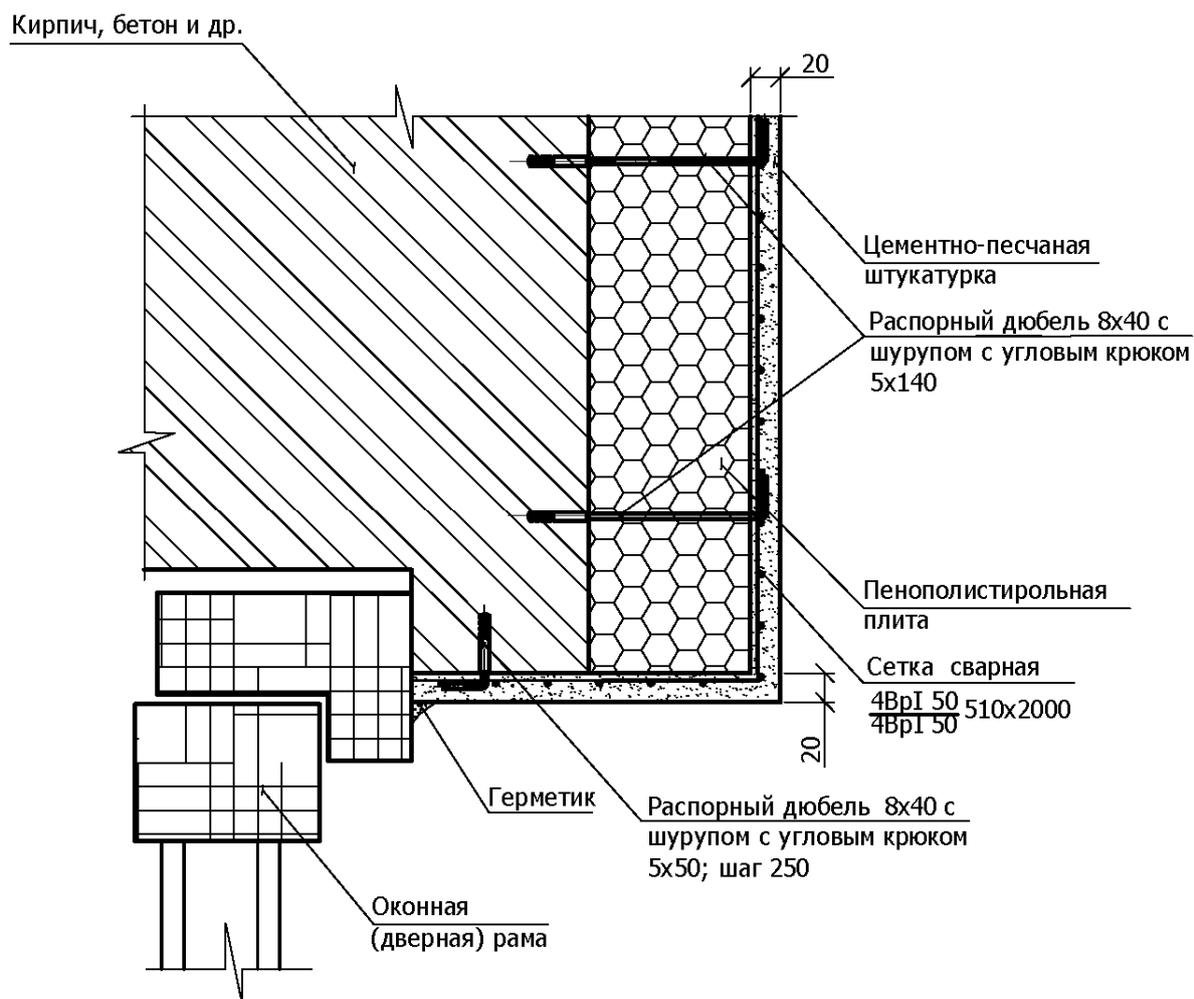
Утепление остекленных лоджий, балконов и воздушных переходов незадымляемых лестничных клеток. Утеплитель – пенополистирольная плита. Примыкание системы к оконной (дверной) раме (вариант 2)
